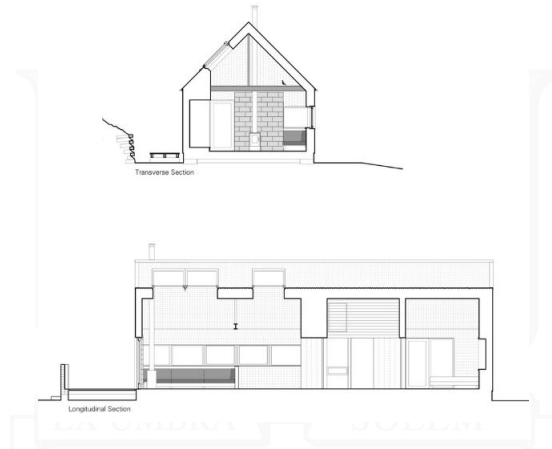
Ejemplo de planos de corte longitudinal y transversal. (Fuente: Planos de Arquitectura (2018))
